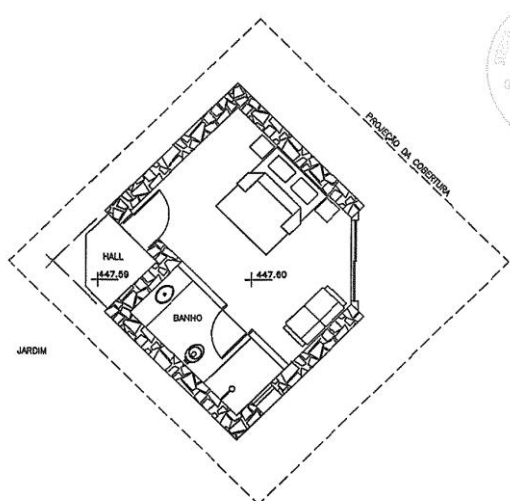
Planta piso 0. Fonte: Município de Castanheira de Pêra.
